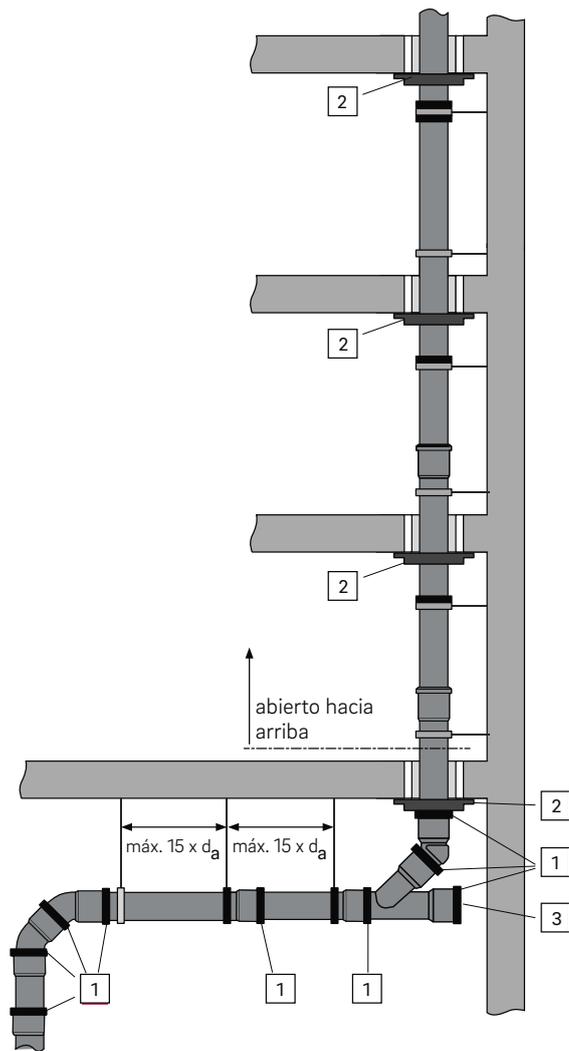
Bajante pluvial de instalación interior (ejemplo)
